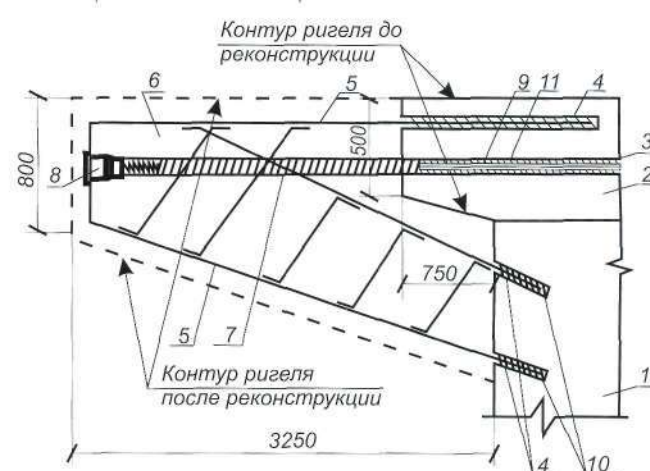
Схема армирования консоли ригеля промежуточной опоры
